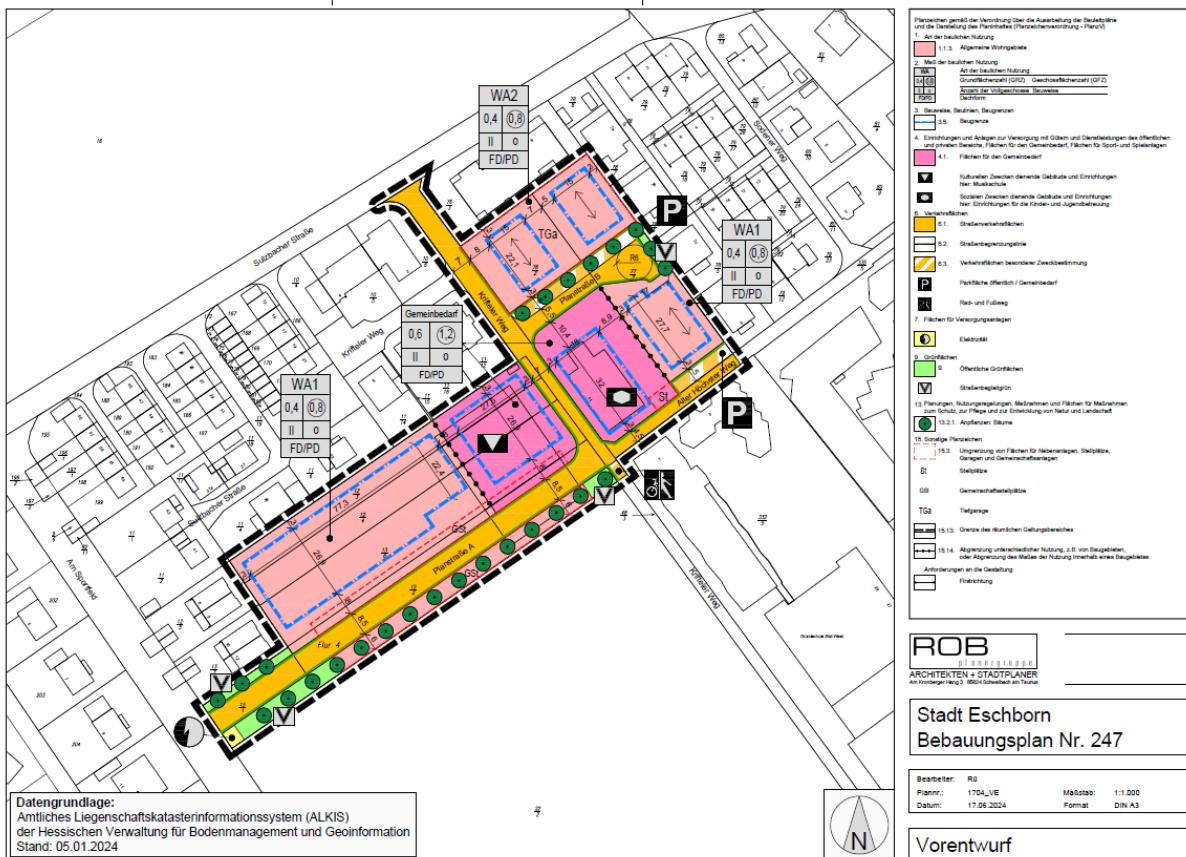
Vorentwurfsplanung Bebauungsplans in Eschborn. Quelle: Planergruppe ROB GmbH
